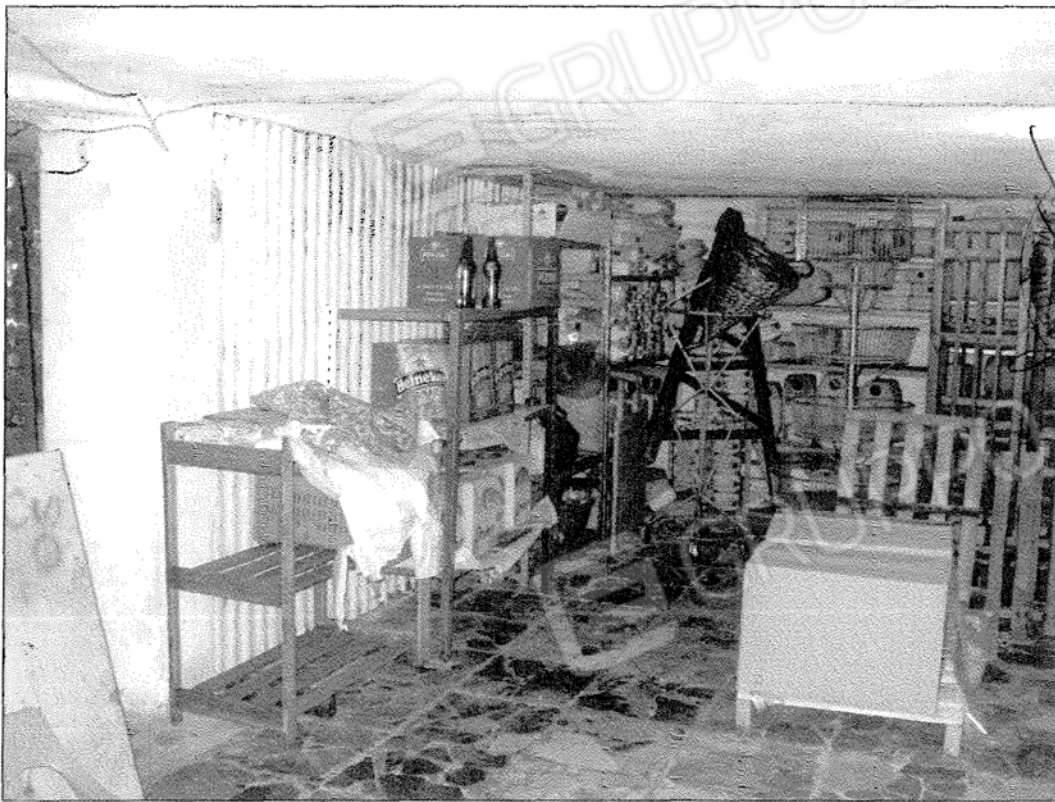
Vista interna dei magazzini di altezza 1,8 m compresi nel lotto n. 4
